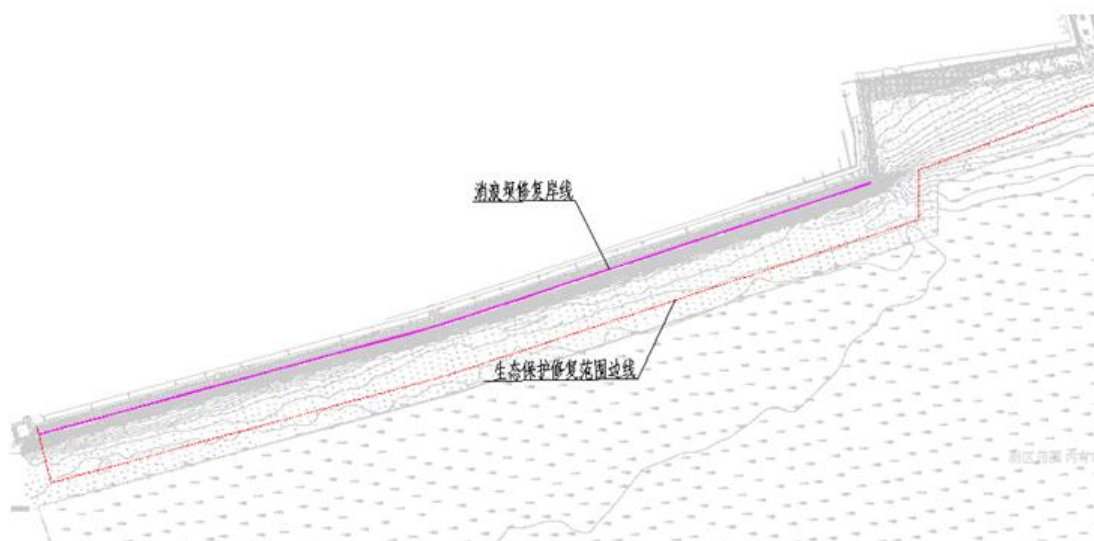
华电灰坝东圈围大堤岸段原设计消浪坝修复平面图
